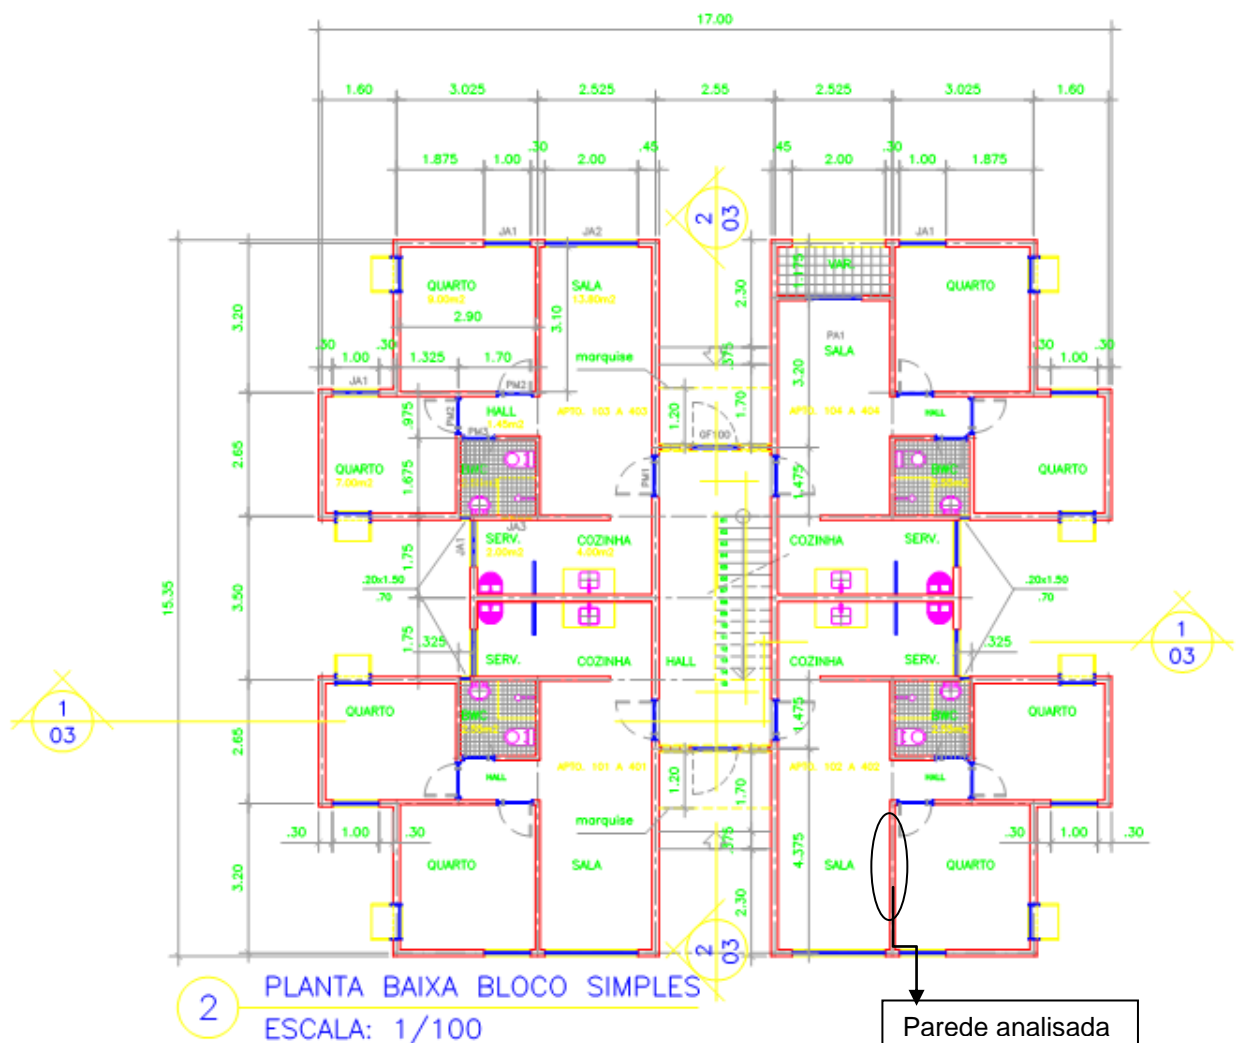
Planta baixa (COREL DRAW, 2017)
